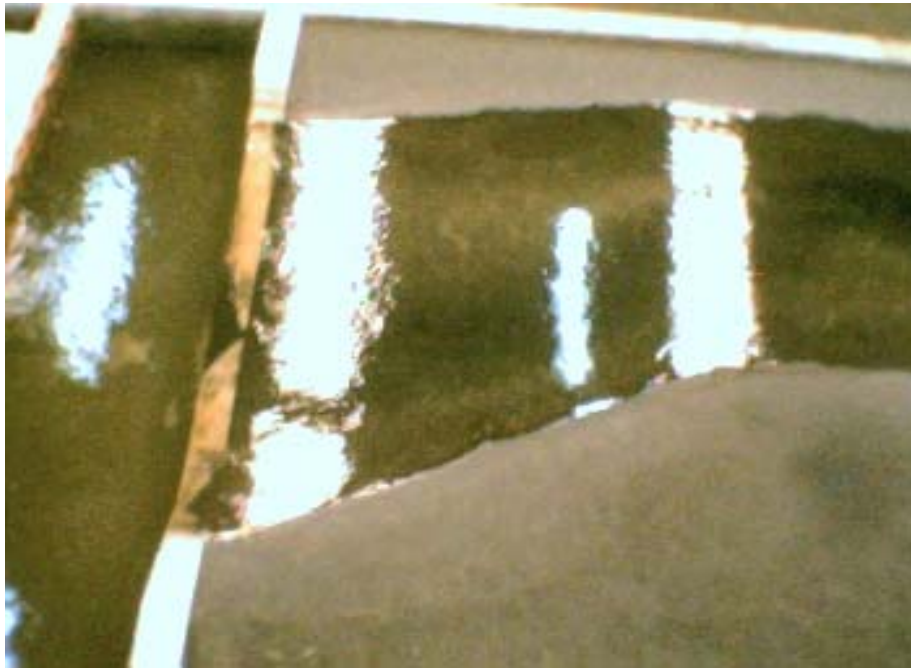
Detalle de forma y distribución de las pilas.
